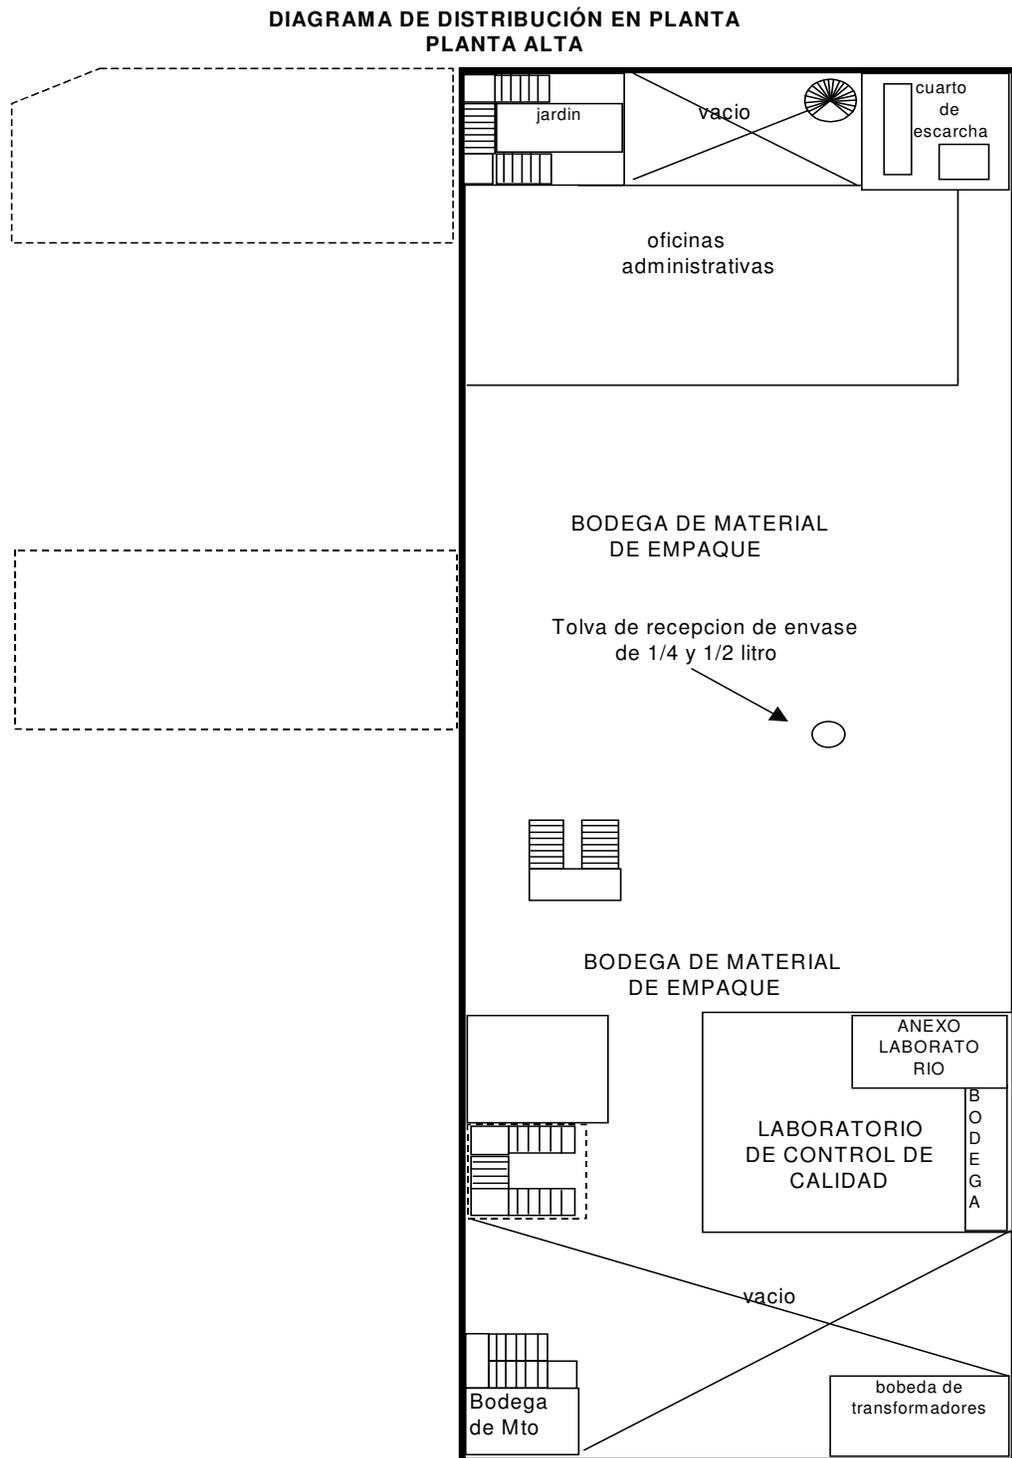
Distribución de la planta Jugos y Refrescos planta alta
